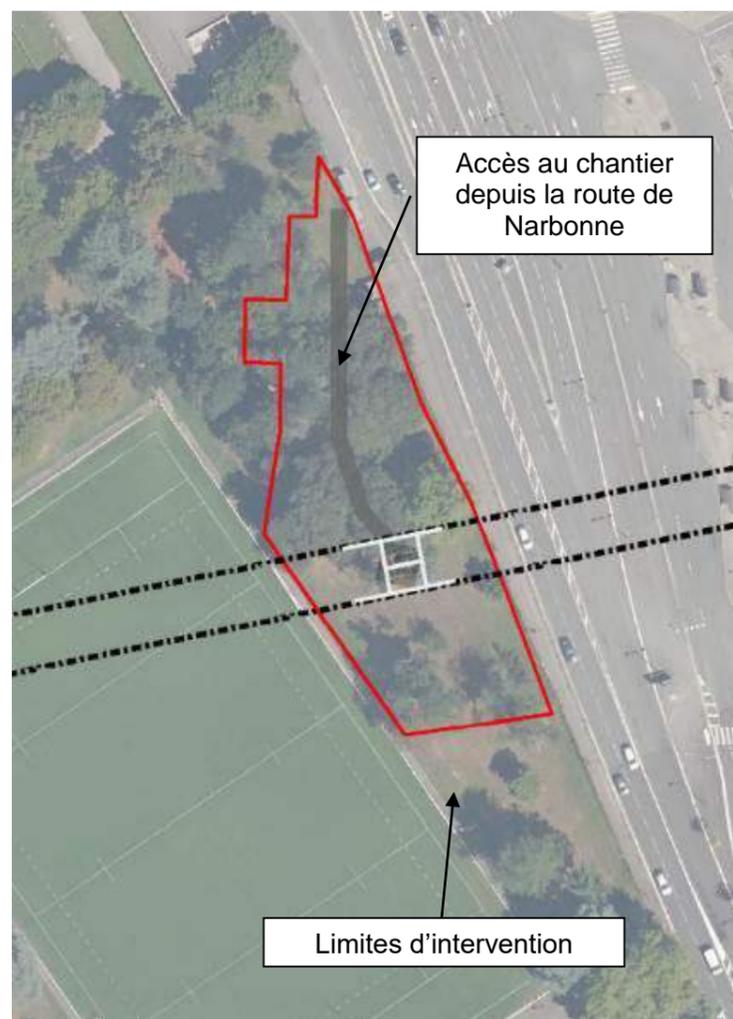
Plan de la zone travaux du pylône 5 (Source : Groupement POMA, 2018)
